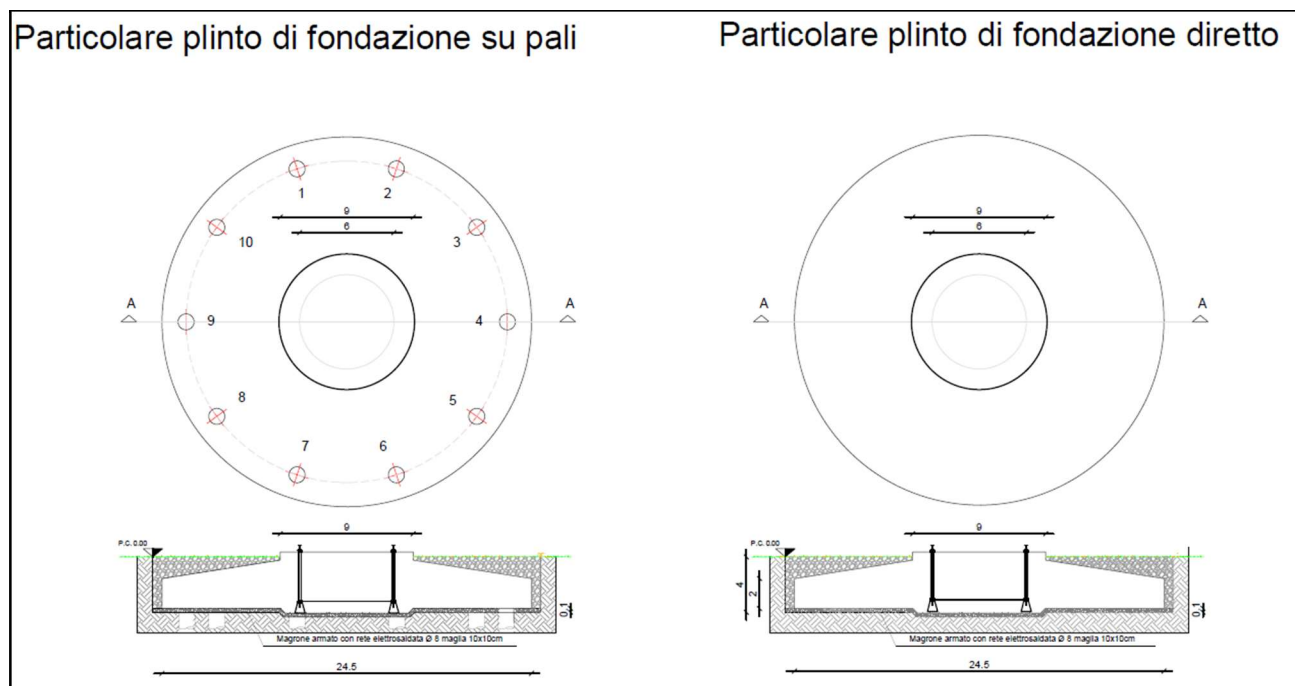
Fondazioni tipo per l’installazione degli aerogeneratori
